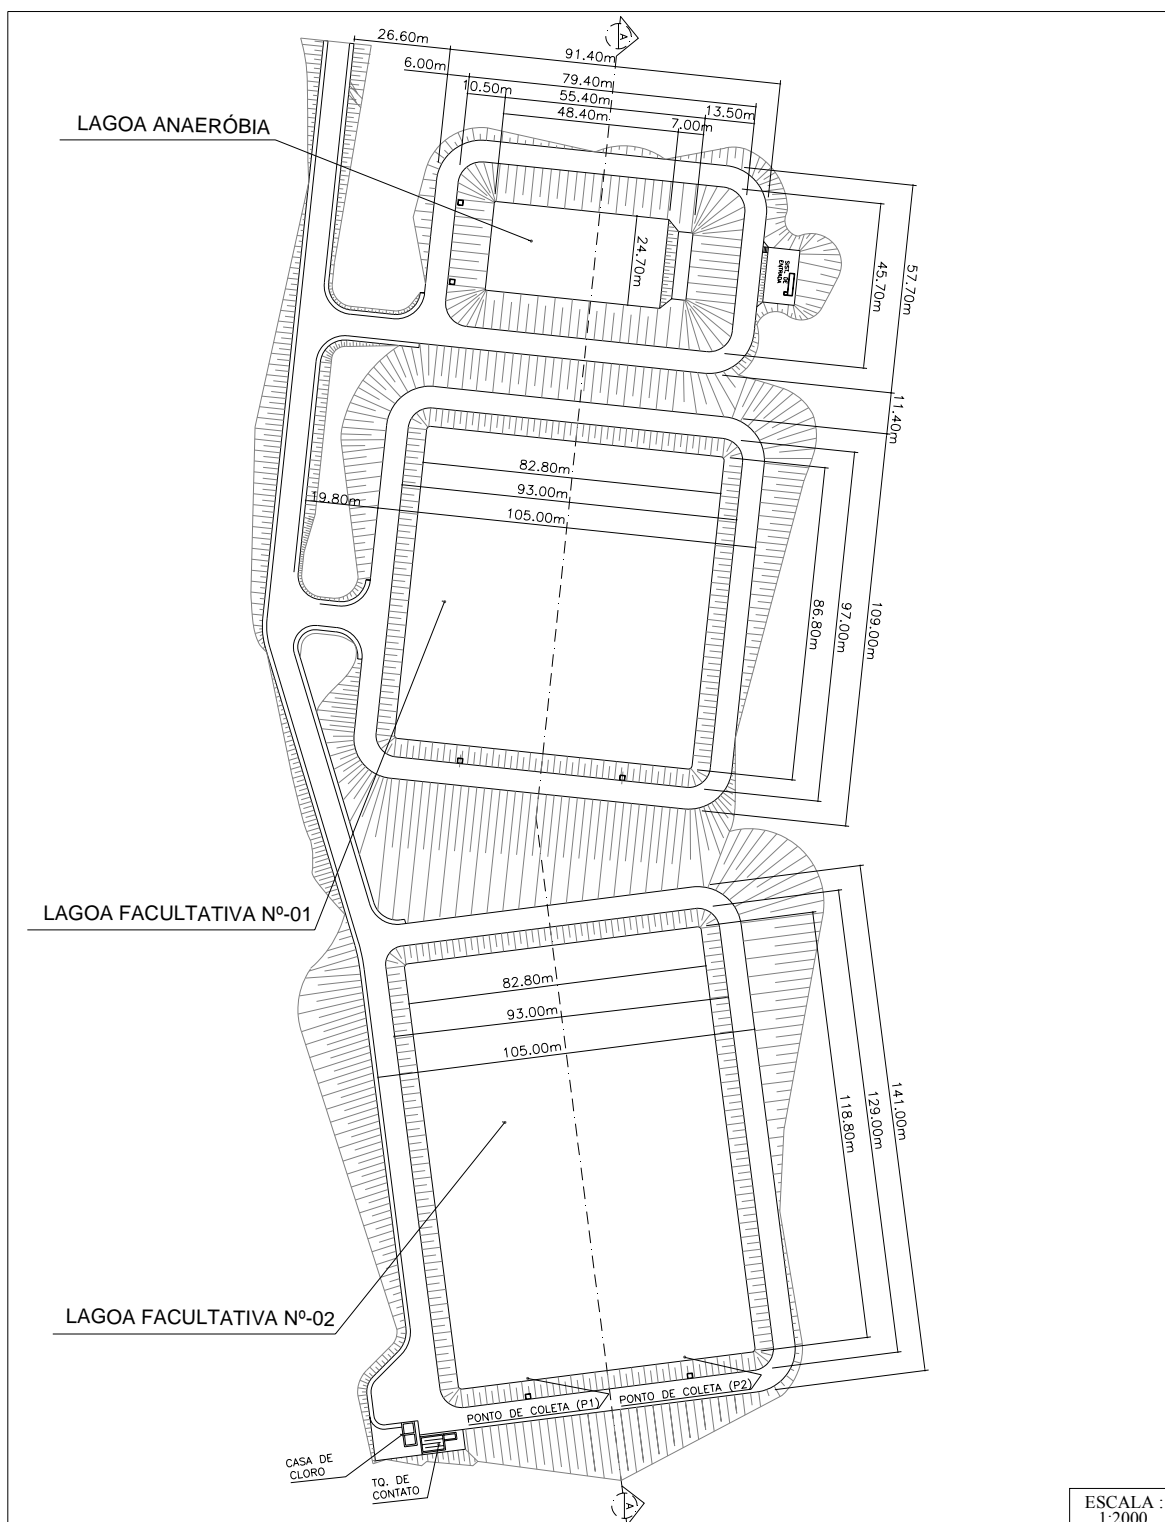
Sistema de esgoto sanitário, vista geral. Fonte: Adaptado, Sabesp (2003).
